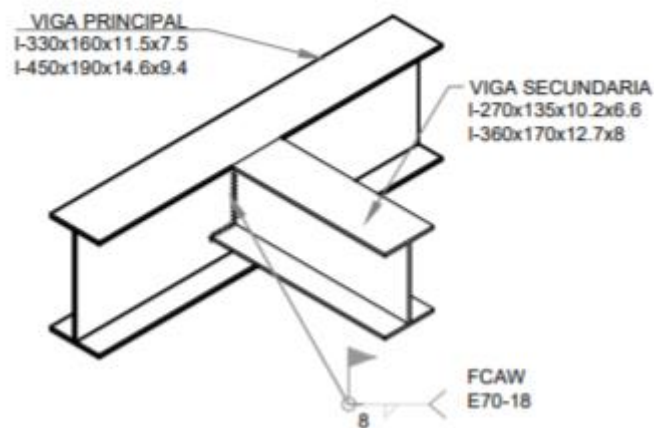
Conexión entre vigas principales y secundarias. Elaboración propia, 2019.
